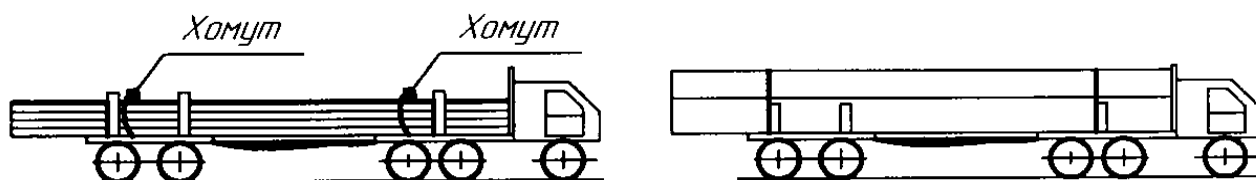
Схемы укладки труб на специализированные транспортные средства
